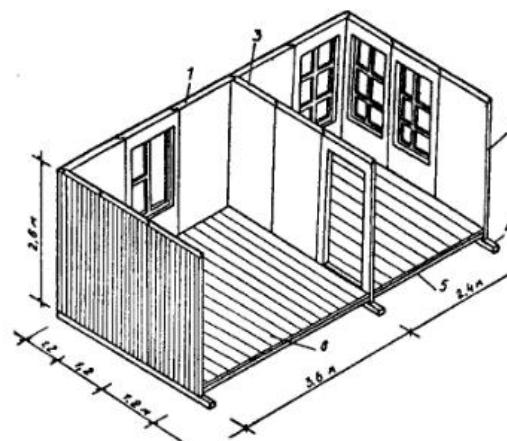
Монтажная схема деревянных стен панельной конструкции: 1 — панель стеновая наружная; 2 — панель веранды; 3 — панель перегородки; 4 — обвязка; 5 — балка перекрытия; 6 — доски пола.
